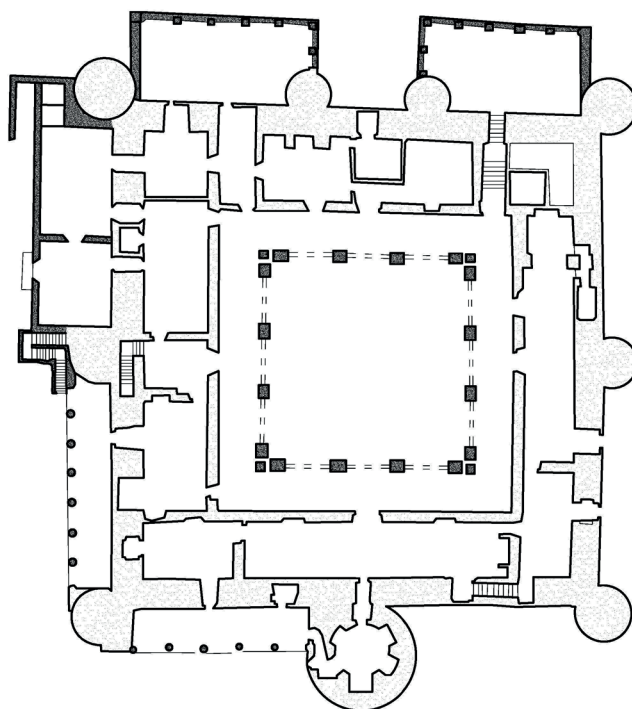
PLANO DEL ALCÁZAR DE ZAFRA, PLANTA PRINCIPAL
